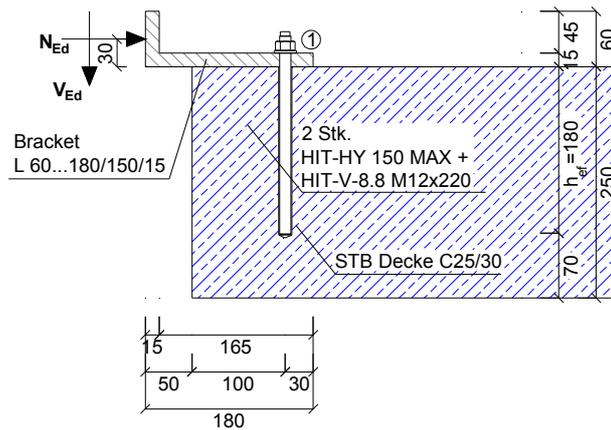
Anschlussdetail F1 Dübel Variante 1 (Maße in mm)
